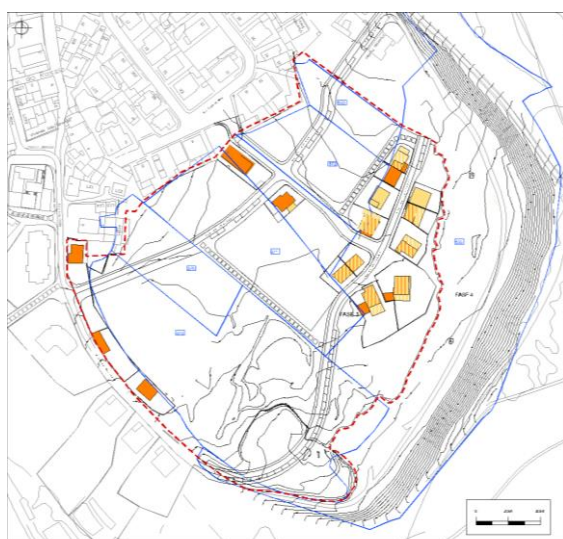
Planta síntese do projeto de loteamento da fase 3 de 2009. Fonte: CMO/DPE
